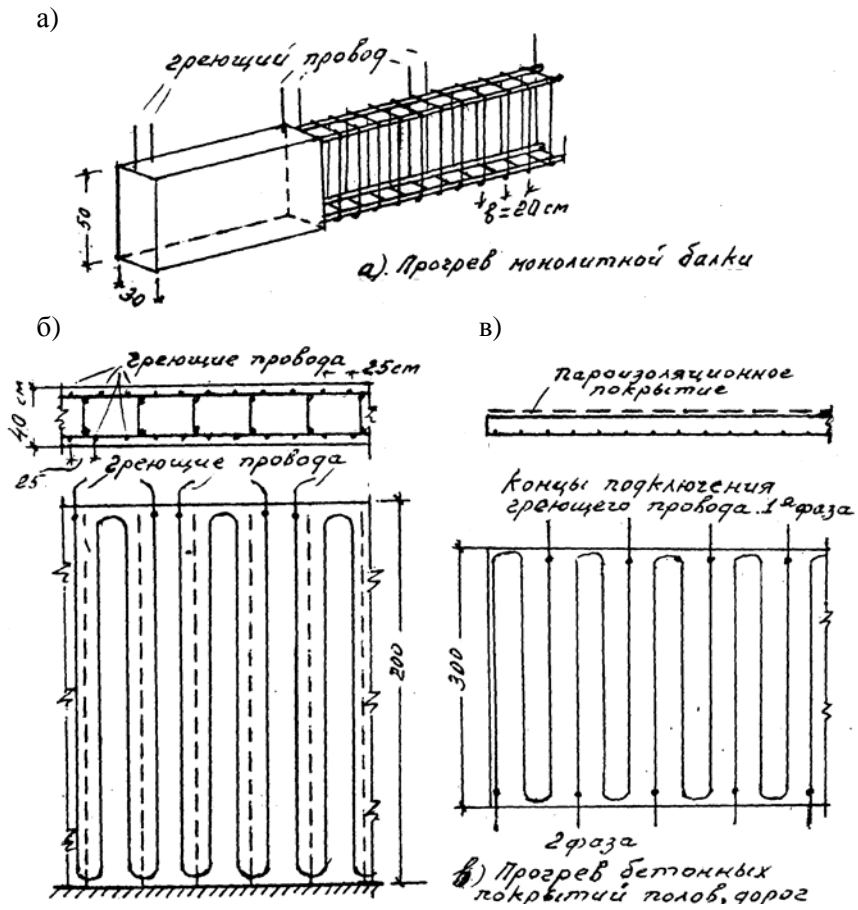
Примеры прогрева бетона с использованием полимерного греющего провода:
